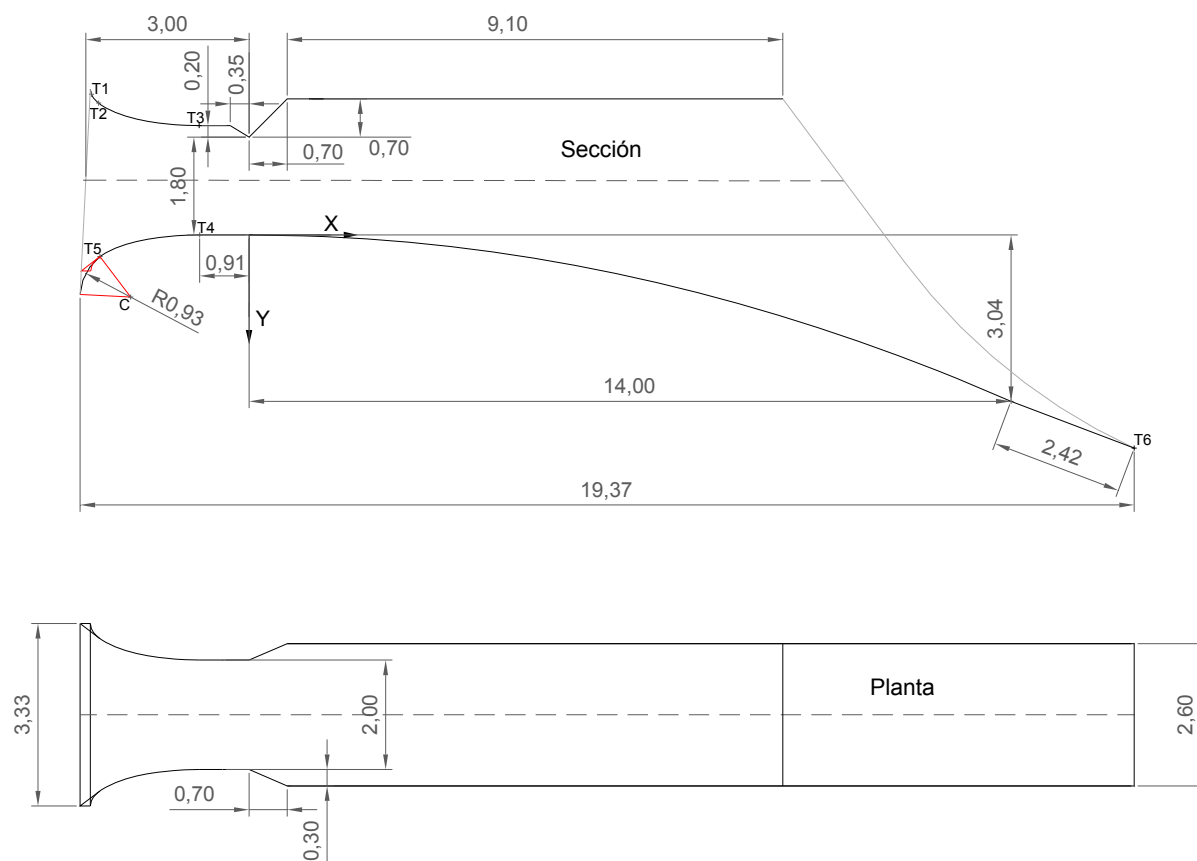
Sección y planta de la nueva geometría del aliviadero A3
